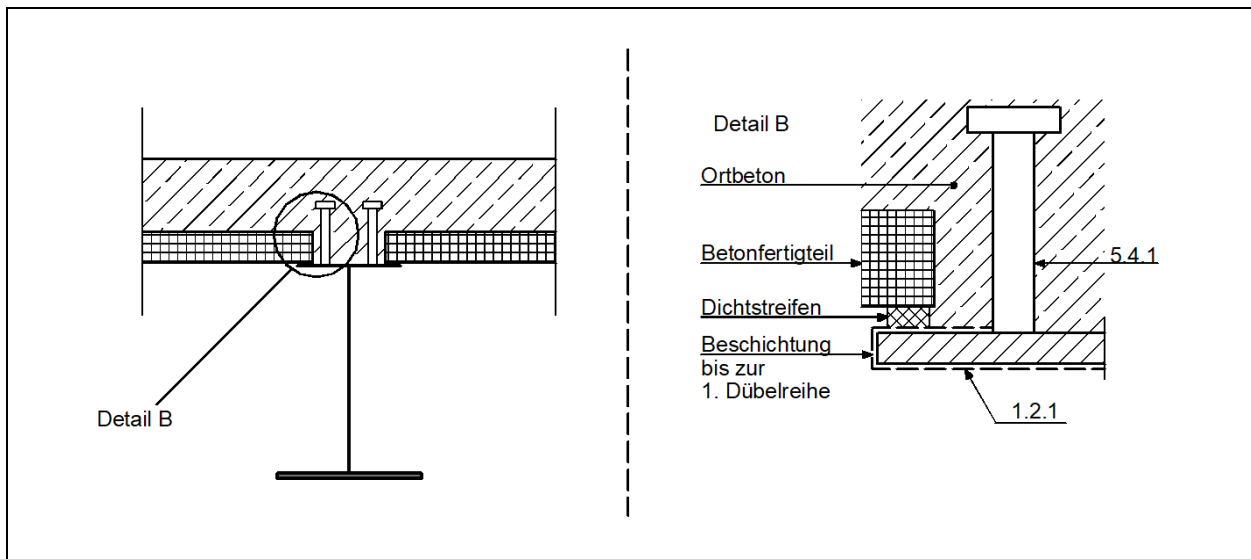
Detailquerschnitt in Verbundbauweise mit Betonfertigteilen und Ortbetonergänzung
